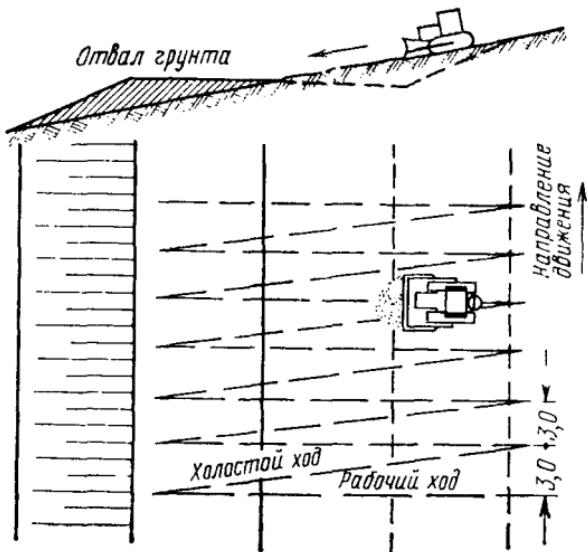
Схема разработки полок бульдозерами на склонах от 8 до 15° поперечными проходами
